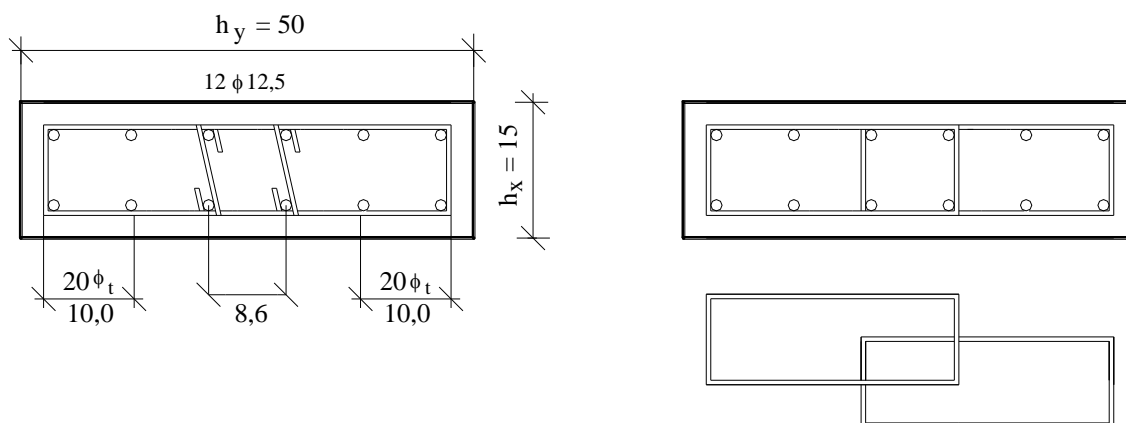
Detalhamento da armadura na seção transversal do pilar P5.
